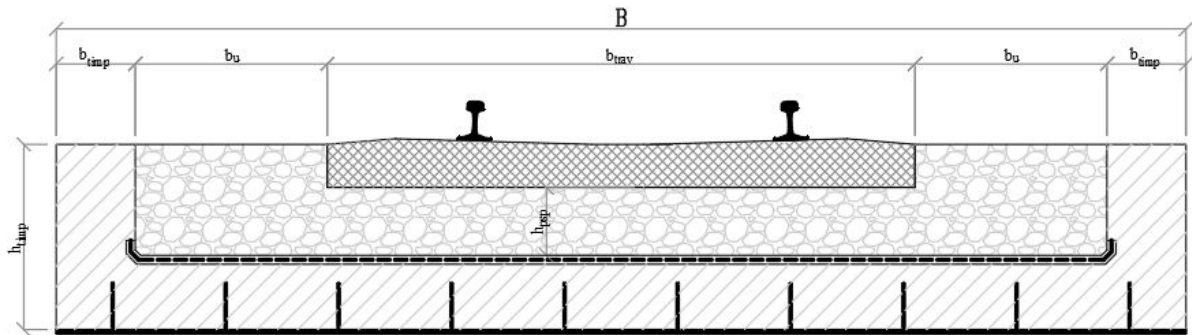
1 – Secțiune transversală dală cu secțiune mixtă oțel-beton – structura metalică din platbande
